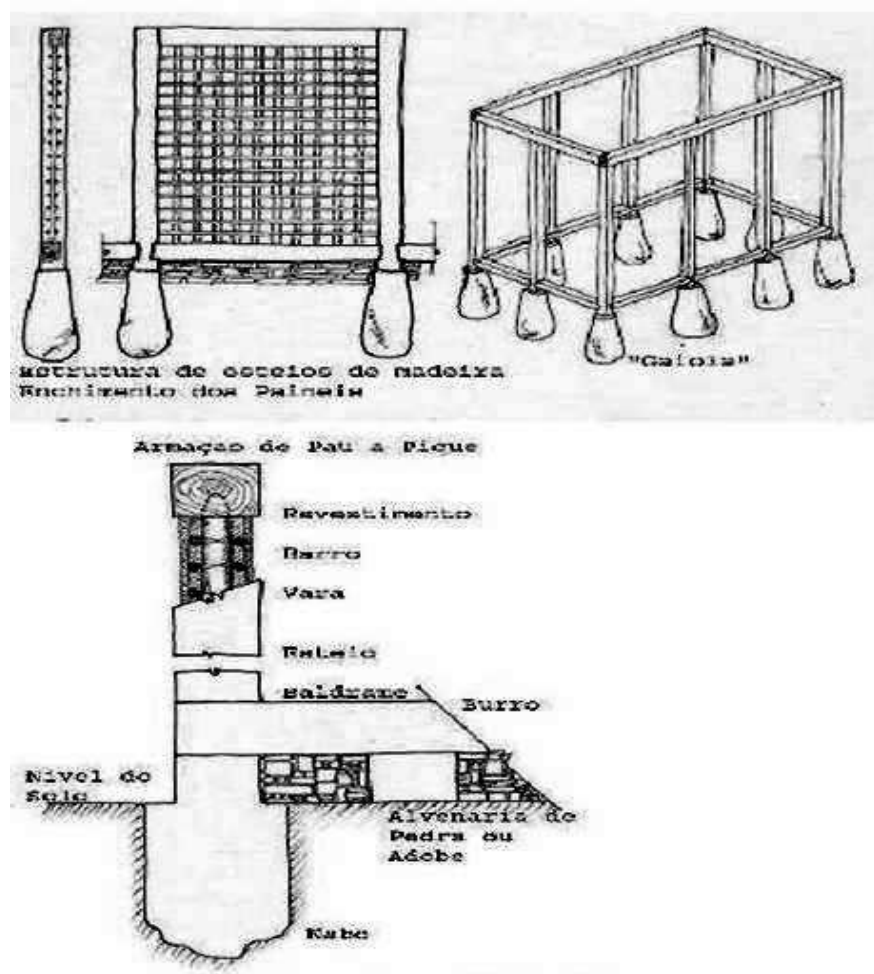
Estrutura de madeira para a execução da taipa de mão detalhe da taipa de mão
